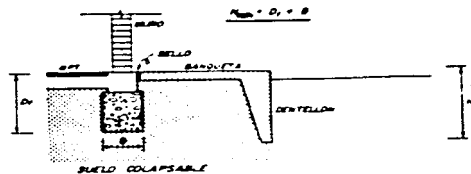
DENTELLÓN, MURETE Ó FALDÓN
